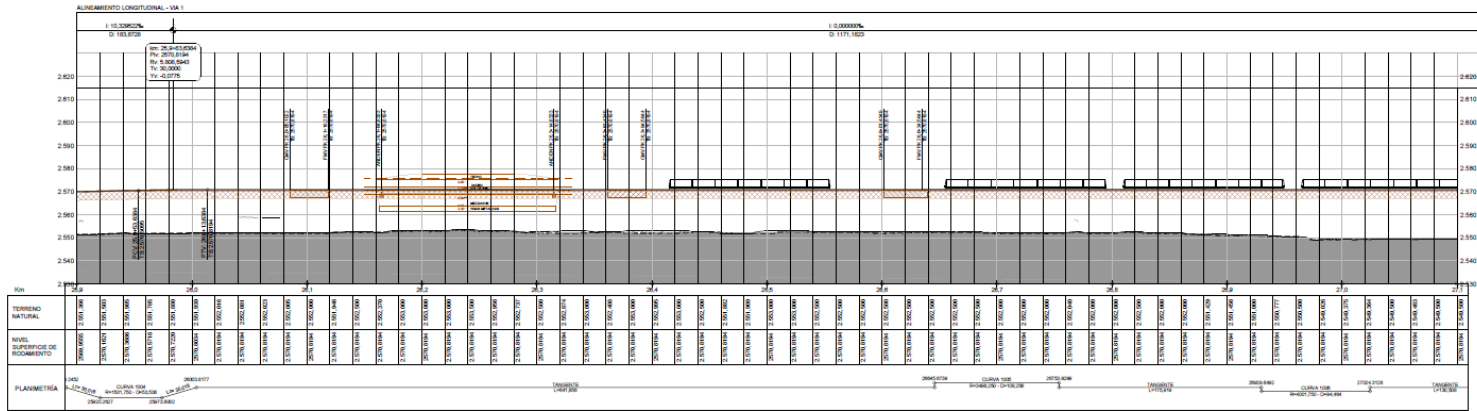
Perfil longitudinal del trazado extensión PLMB-Tramo1, Tramo calle 100 Norte – Via 2
